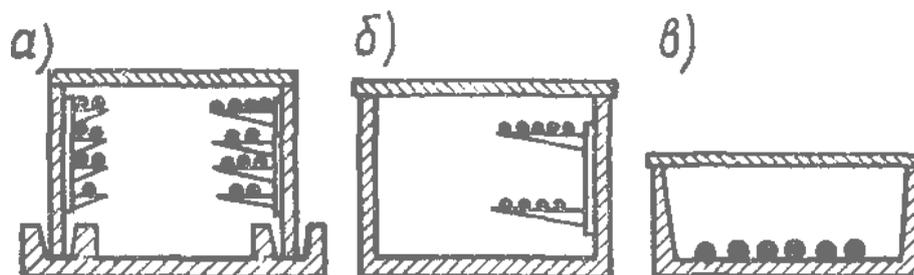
Сборные железобетонные каналы и расположение в них кабелей:
